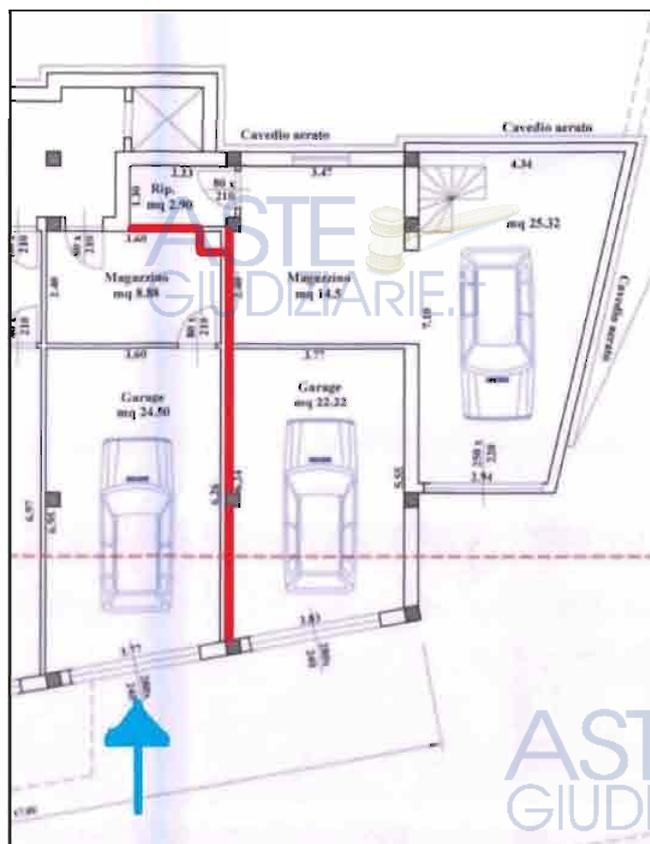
Immobile A_21, autorimessa e magazzino piano seminterrato (Planimetria di progetto)
